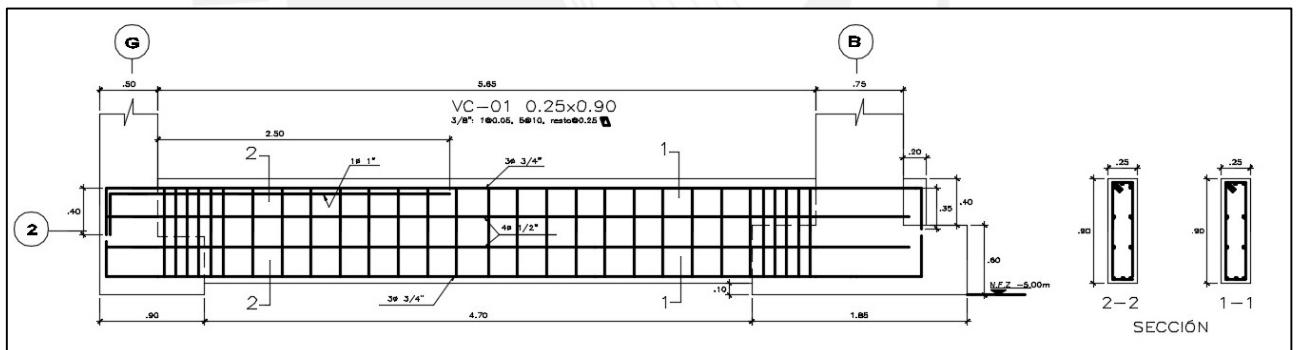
Diseño final de la viga de cimentación VC-01.
